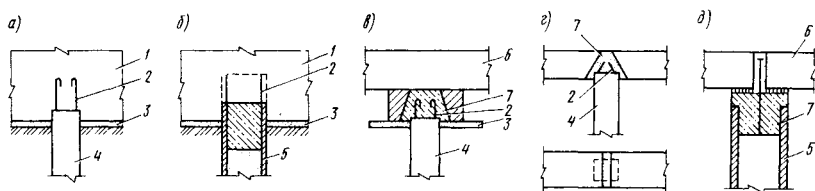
Конструкции соединения свай с ростверком при жестком соединении: а — квадратной свай с монолитным ростверком; б — то же, полой круглой свай; в — квадратной свай с помощью сборного железобетонного оголовка; г — квадратной свай со сборным ростверком; д — то же, полой круглой свай; 1 — монолитный ростверк; 2 — выпуски арматуры; 3 — бетонная подготовка; 4 — свая квадратного поперечного сечения; 5 — полая круглая свая; 6 — сборный ростверк; 7 — заполнение бетоном
